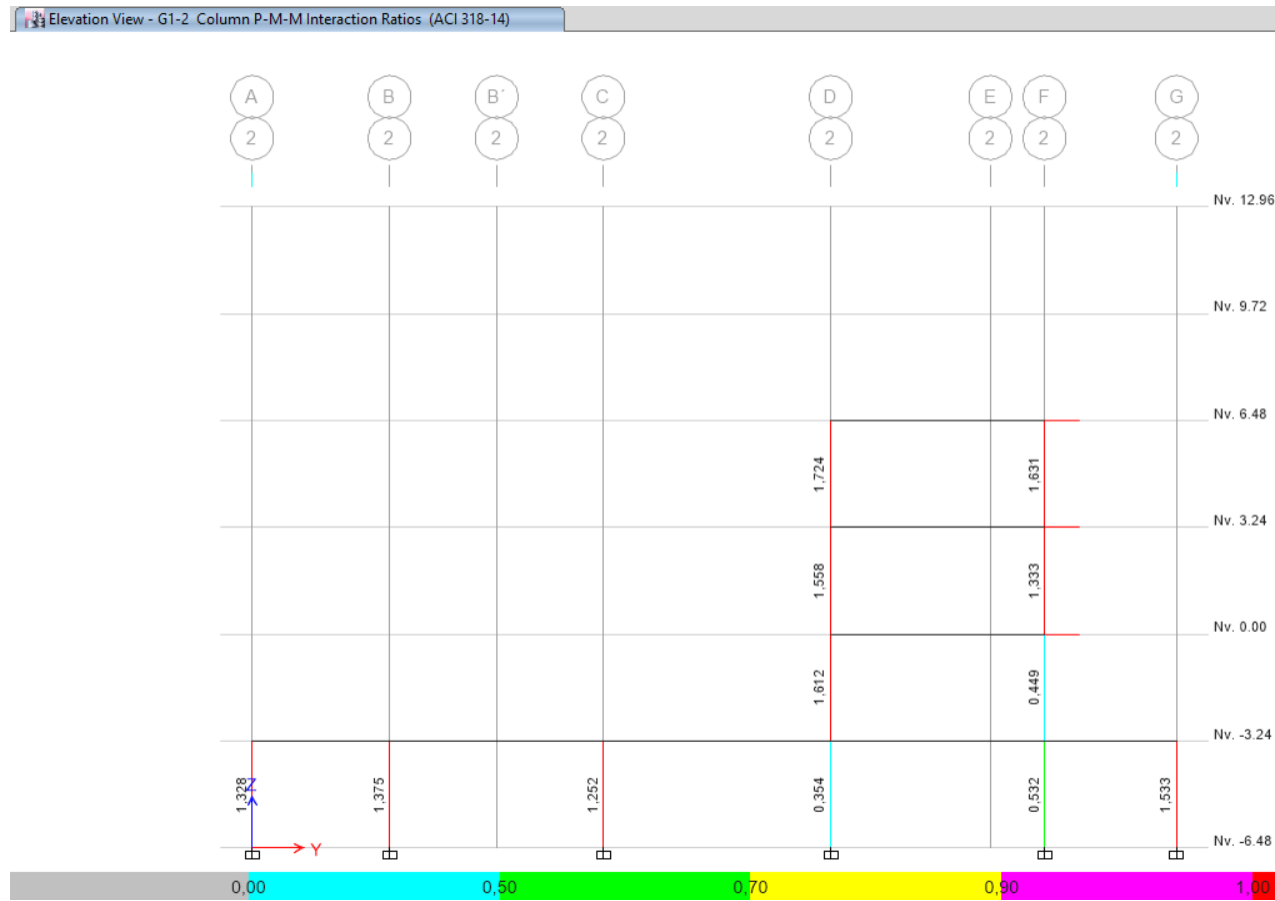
Vista en elevación de la demanda/capacidad en columnas, pórtico eje 1.
